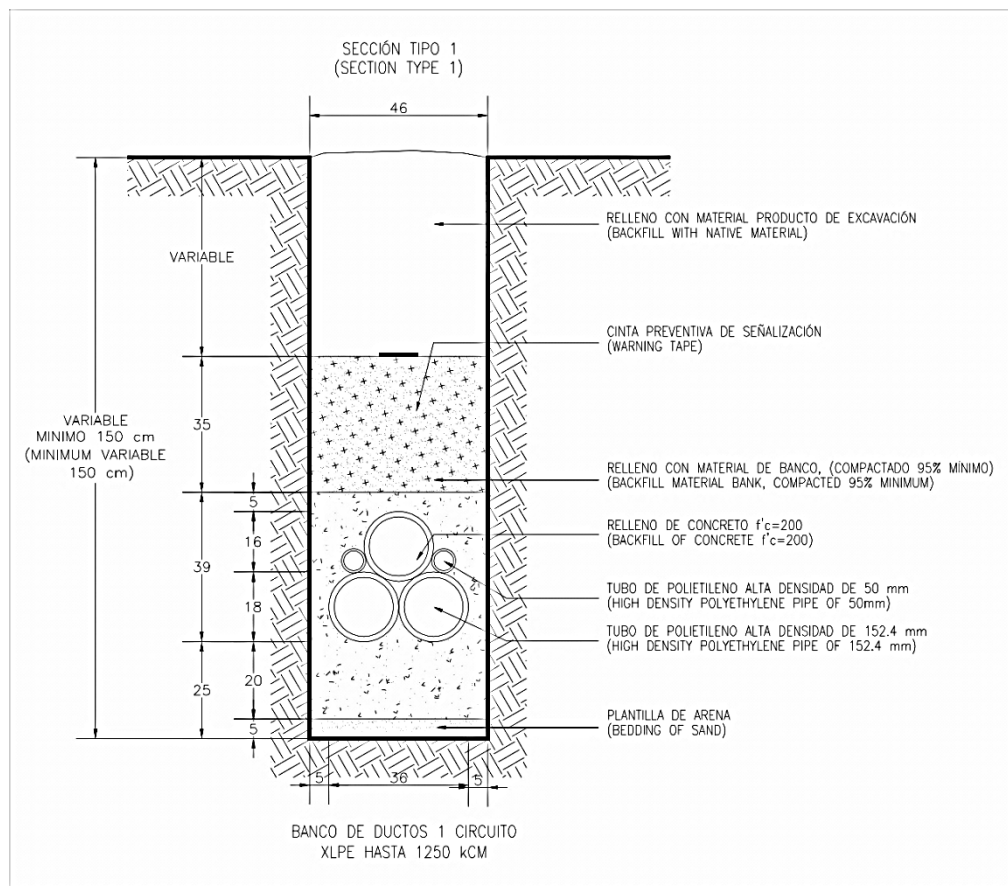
Detalle típico sección 1 de cruce de caminos; extracto de plano de detalles.
